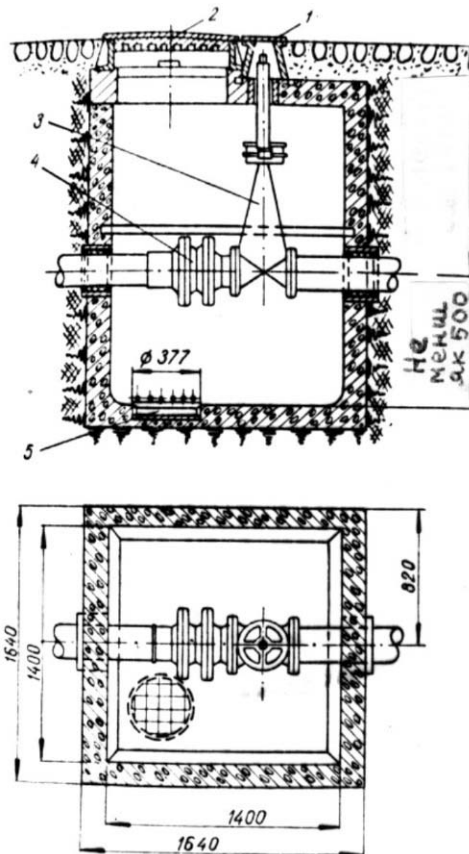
Улаштування залізобетонного колодязя для газової запірної арматури:
